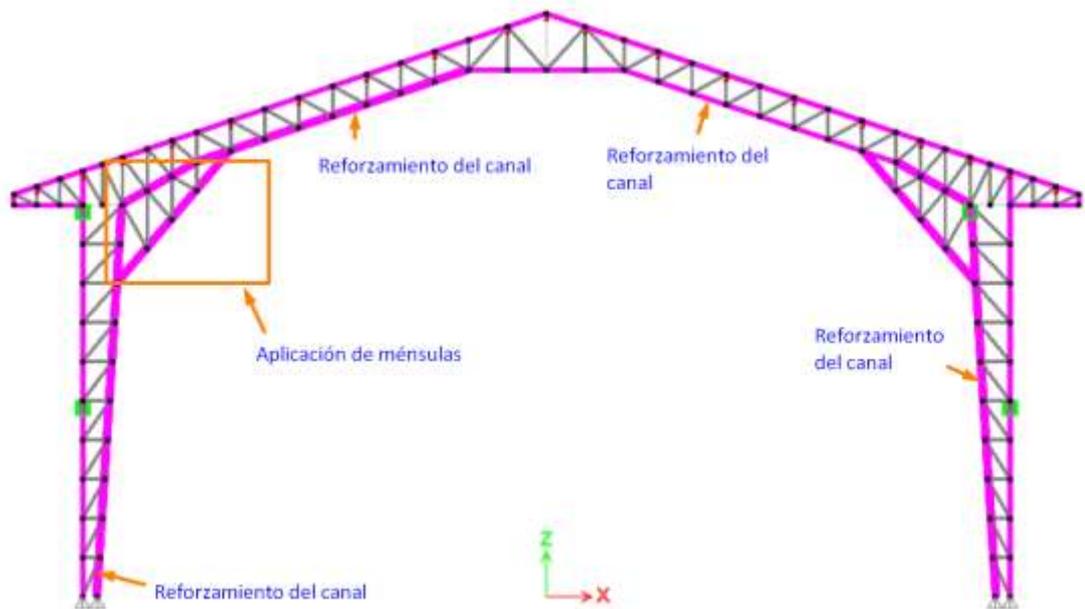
Aplicación de ménsulas y reforzamiento del sistema de los pórticos
